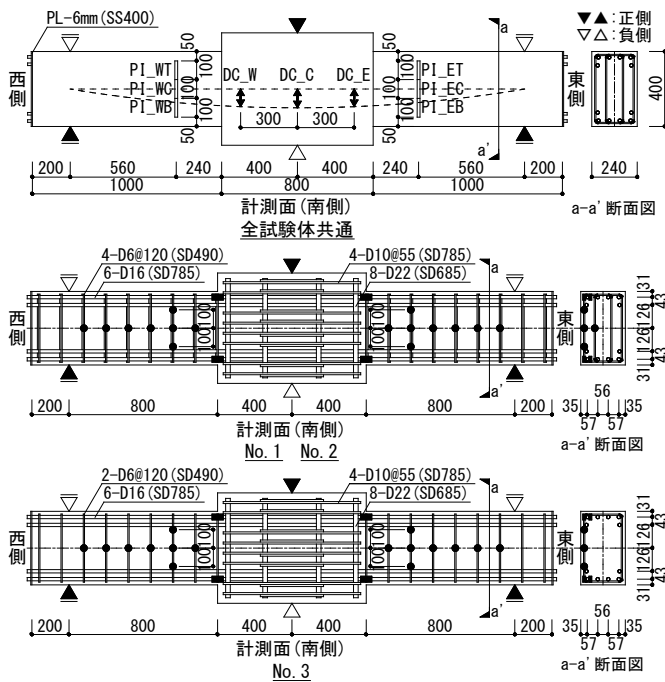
配筋図およびπゲージ、ひずみゲージ位置図
